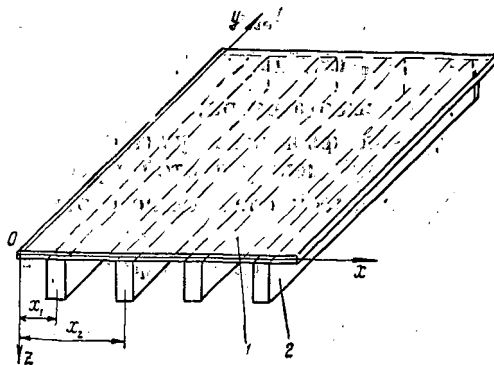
Общий вид плитно-ребристой конструкции: 1 — плита; 2 — ребро
